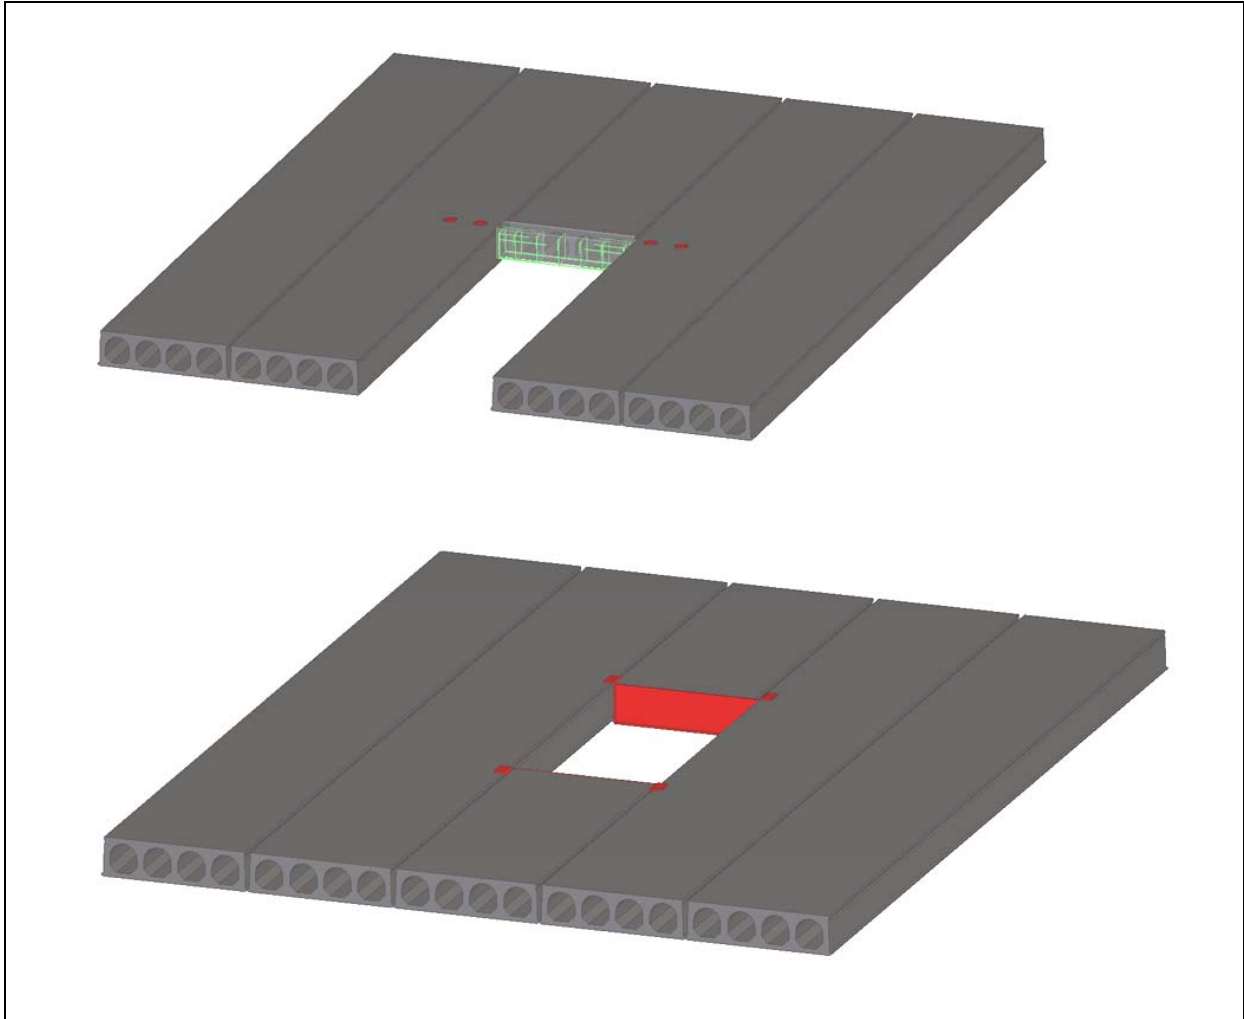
Pienten reikien sallitut koot onteloiden kohdalla (Parma Oy)
